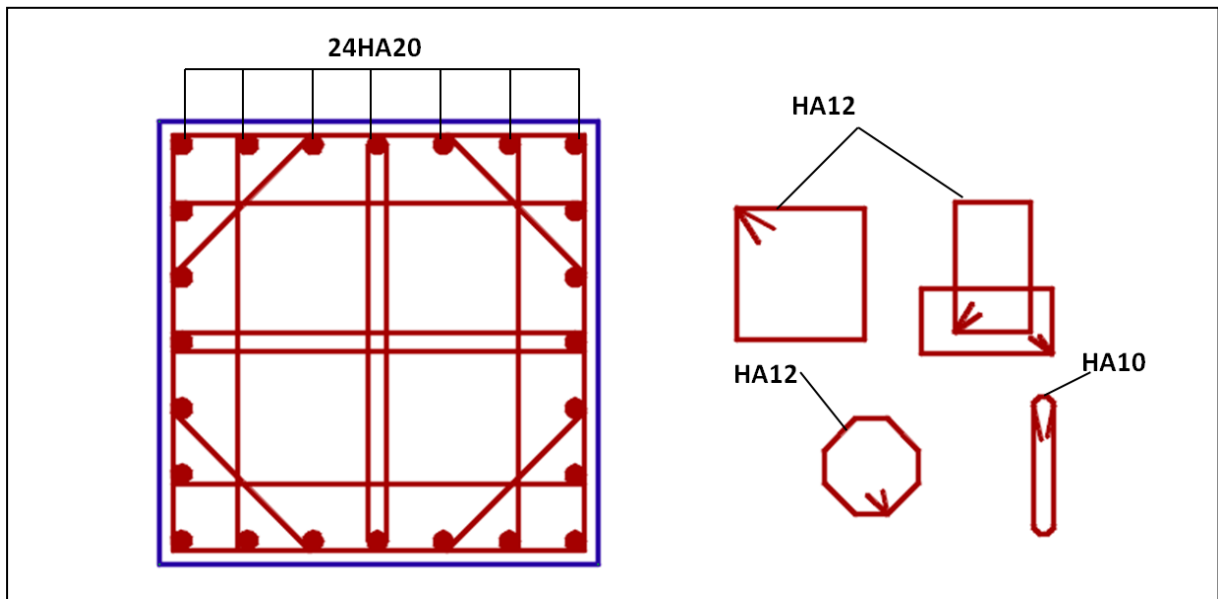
Schéma de ferrailage du poteau 80x80
